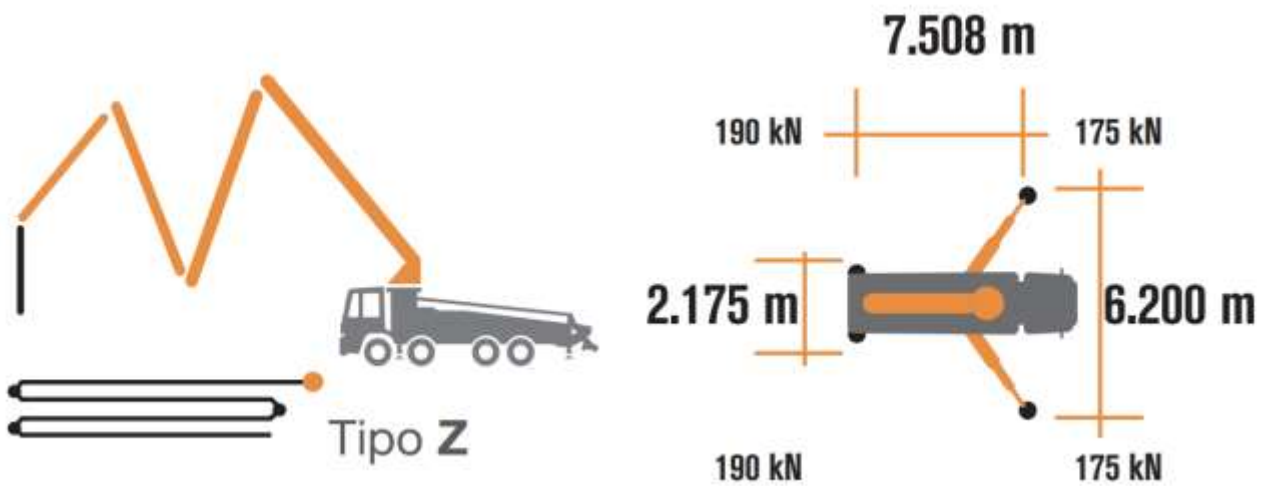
Pompa autocarrata per getti di calcestruzzo con braccio da 30 m: dimensioni e ingombro planimetrico in fase di esercizio.
